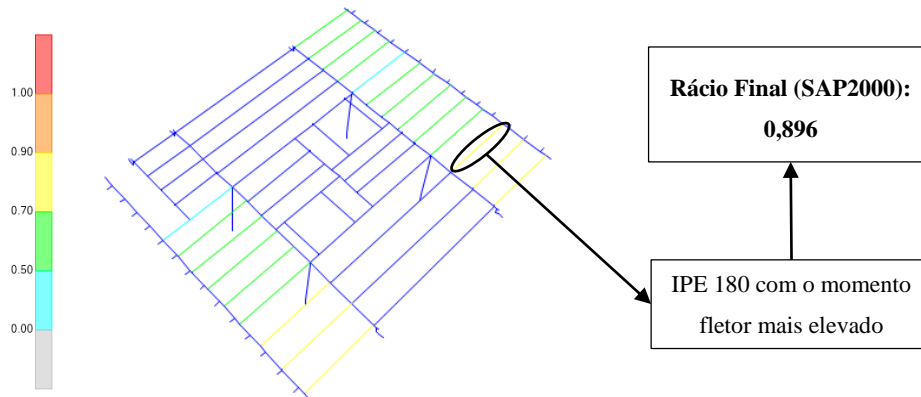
Vigas do piso metálico com um vão de 3,5 m
